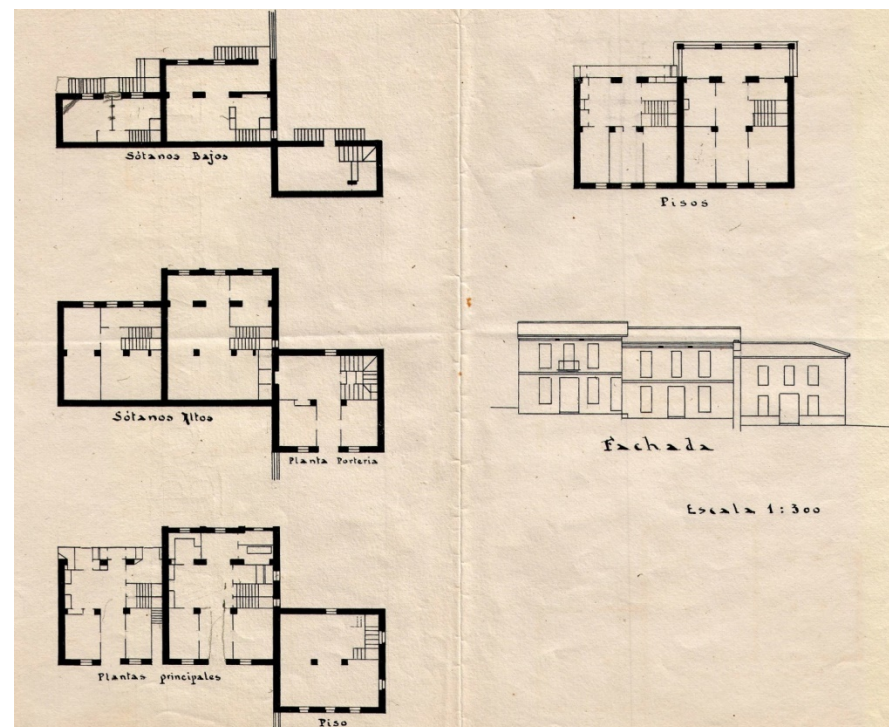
Levantamiento planimétrico viviendas de la entrada y Portería (1923-1929).<sup>458</sup>
